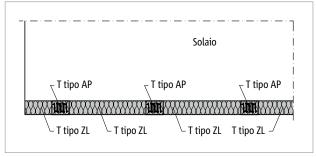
Schöck Isokorb® T tipo AP: disposizione verticale, pianta del parapetto sovrapposto
